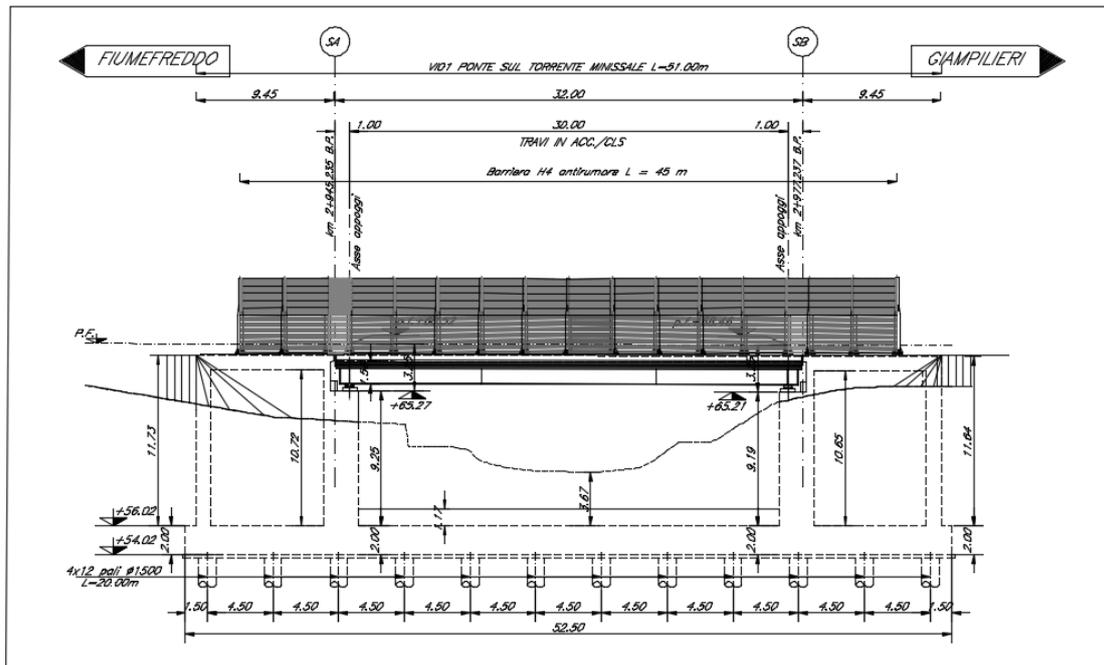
Ponte sul torrente Minissale: sezione trasversale e prospetto
